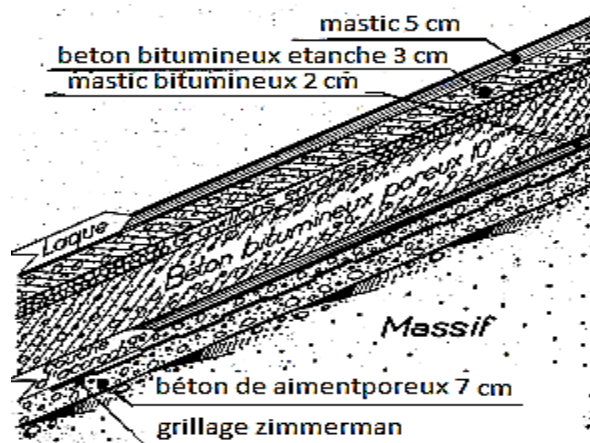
Coupe du masque en béton bitumineux du barrage Sarno (ANBT, ?).
